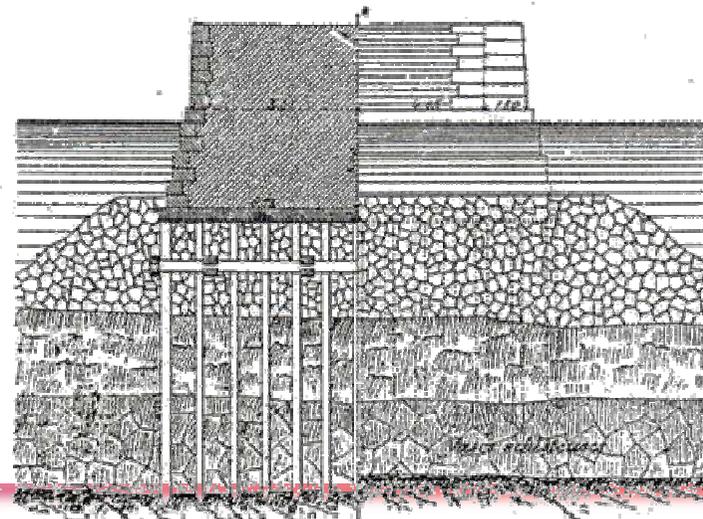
Fondations de ponts sur plateformes. (Pont de Tours sur la Loire).
